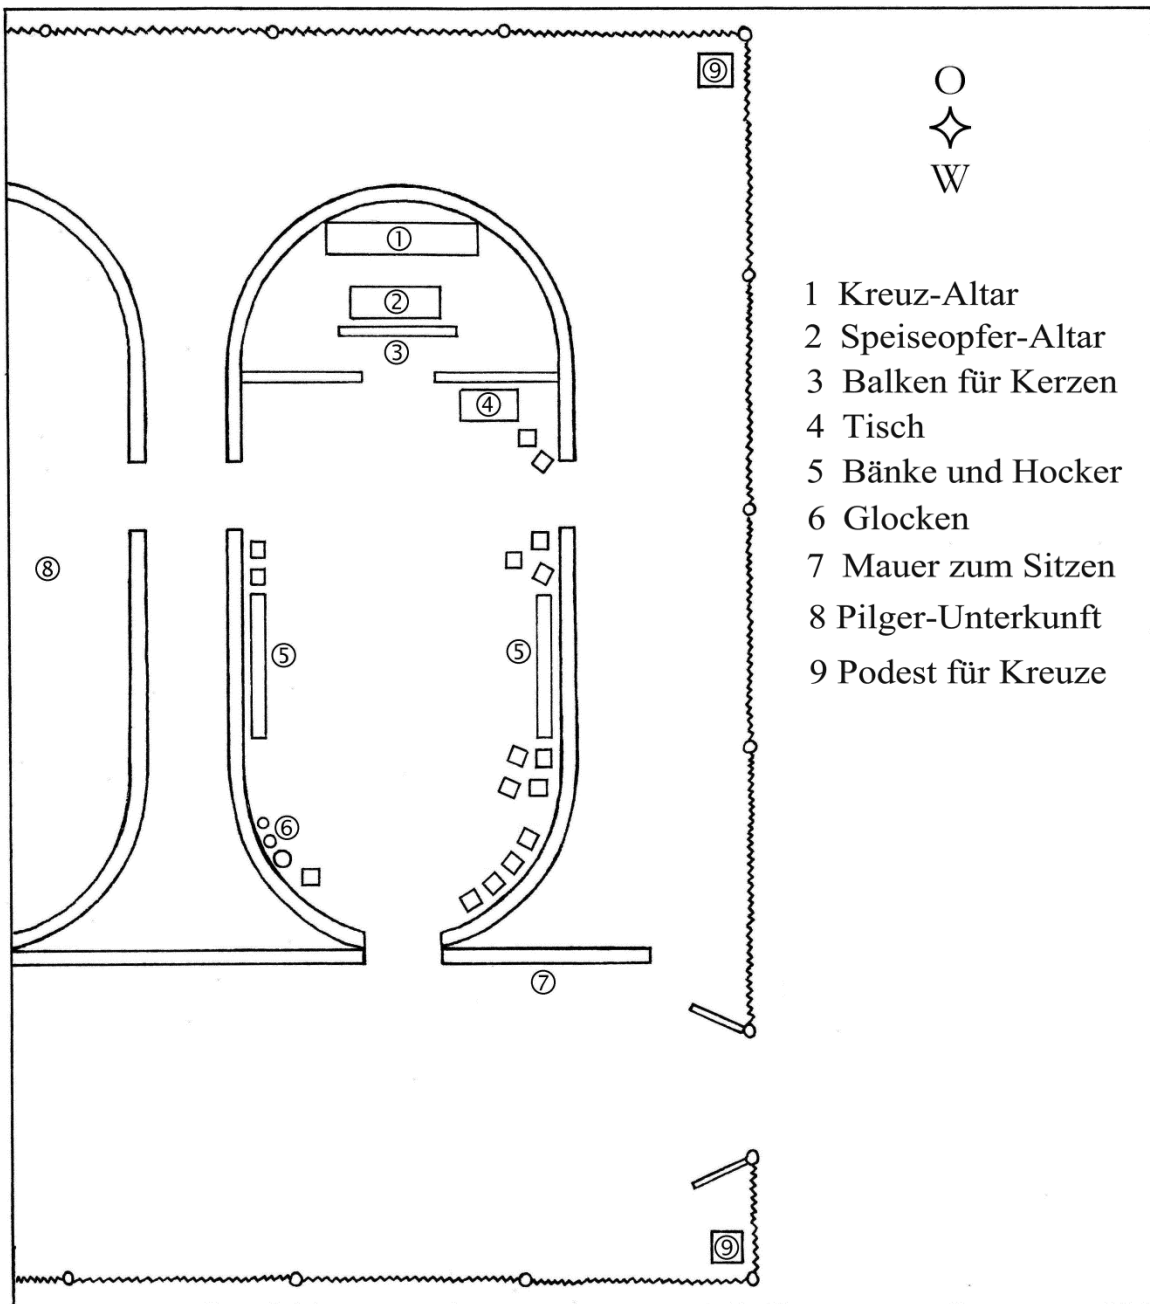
Grundriss der Kreuzkultkirche in Tixcacal Guardia
